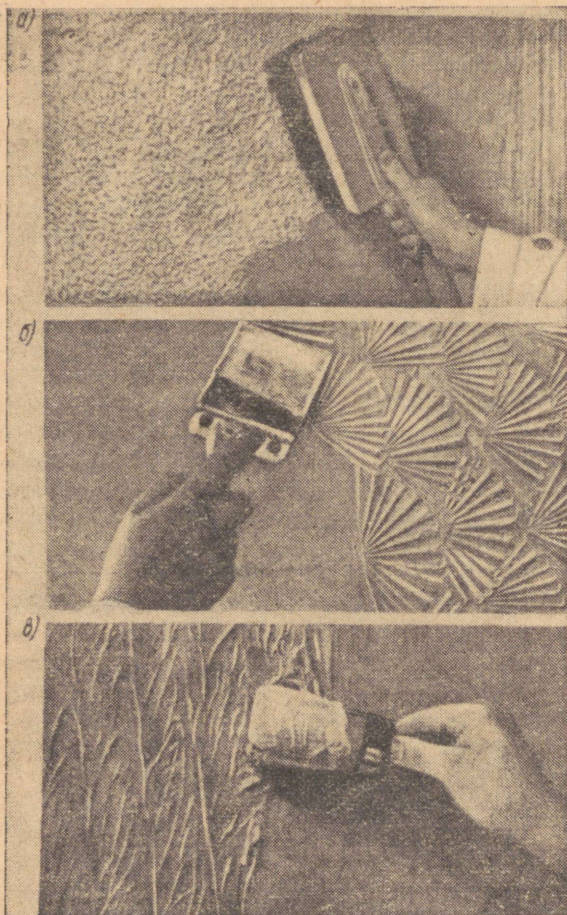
Рельефная отделка поверхности: а) щеткой-торцовкой; б) шпателем; в) кистью, обмотанной тканью.
